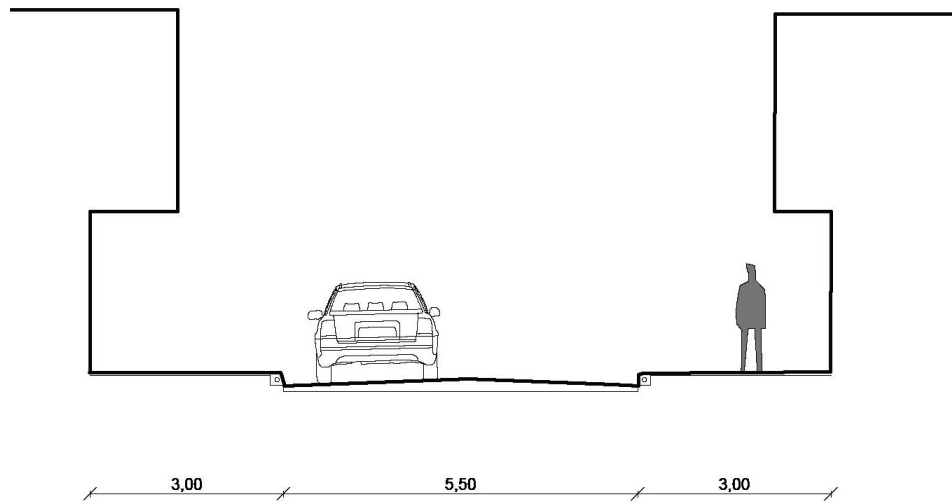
Perfil vial propuesto Carrera 11 tramo centro fundacional
